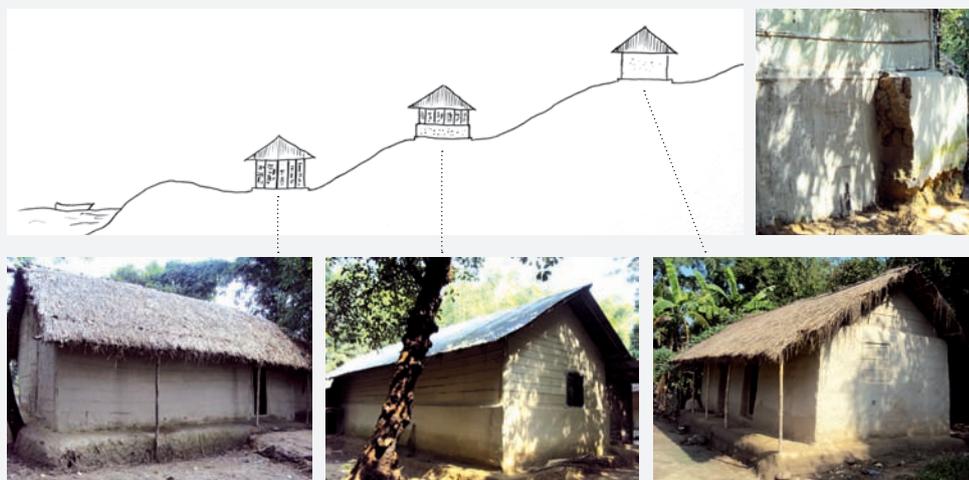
a) croquis : typologies constructives selon site d'implantation ; b) demi mur endommagé par une inondation temporairement remplacé par un panneau avec enduit ; c) structure légère en zone très exposée ; d) demi mur en terre et structure indépendant soutenant la toiture en zone moyennement exposée ; e) construction en terre massive en zone faiblement exposée
